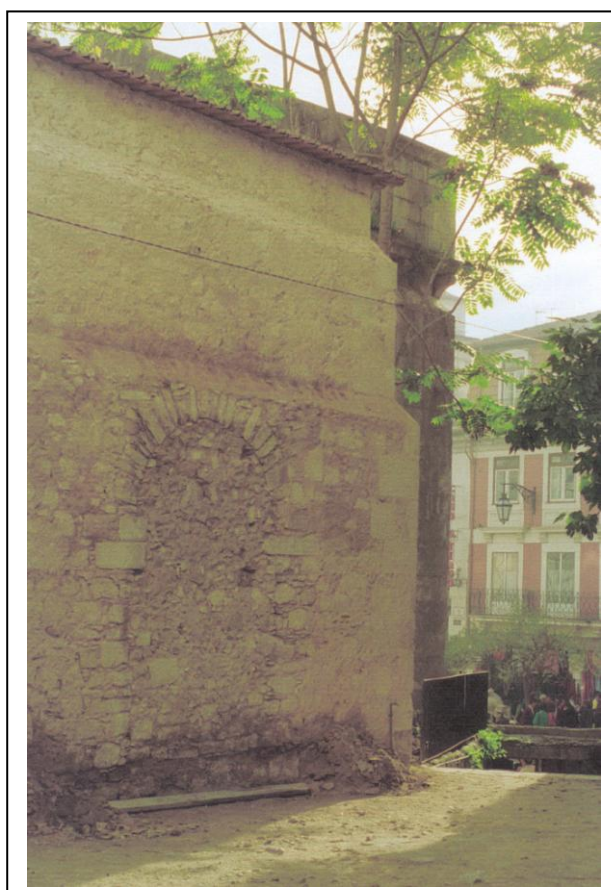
Pormenor de vão na fachada norte. Foto do arquivo da D.G.E.M.N..
